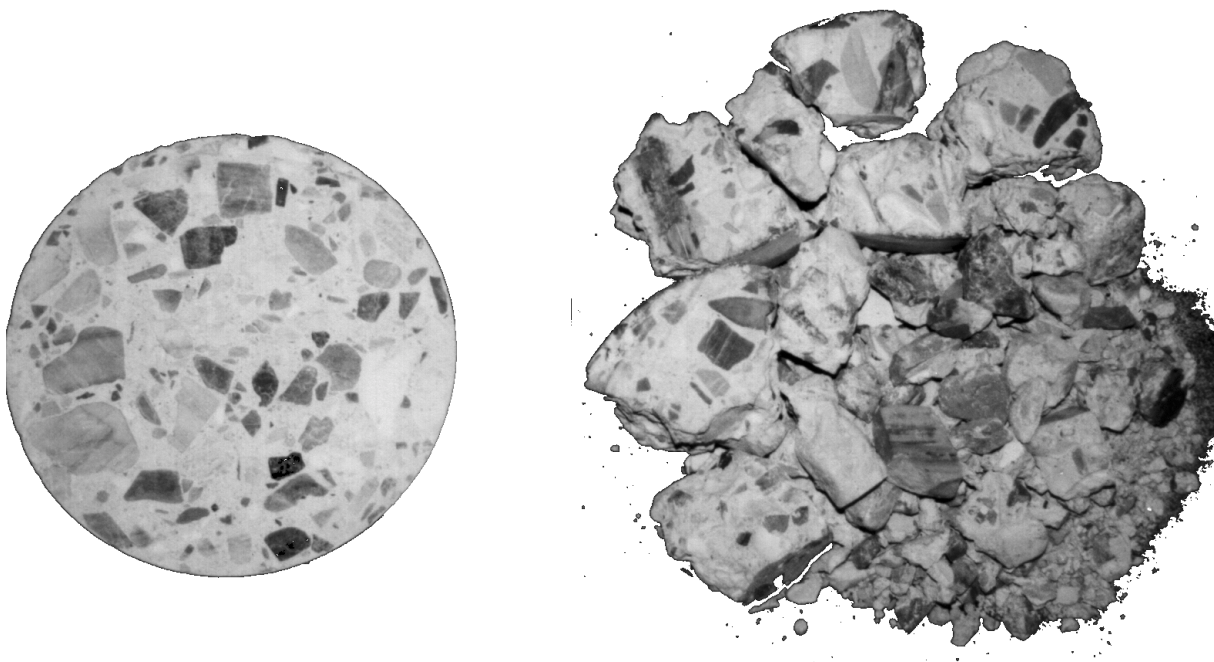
Betonprobekörper vor und nach der Vorzerkleinerung (B25, Korngruppe 0/16)
